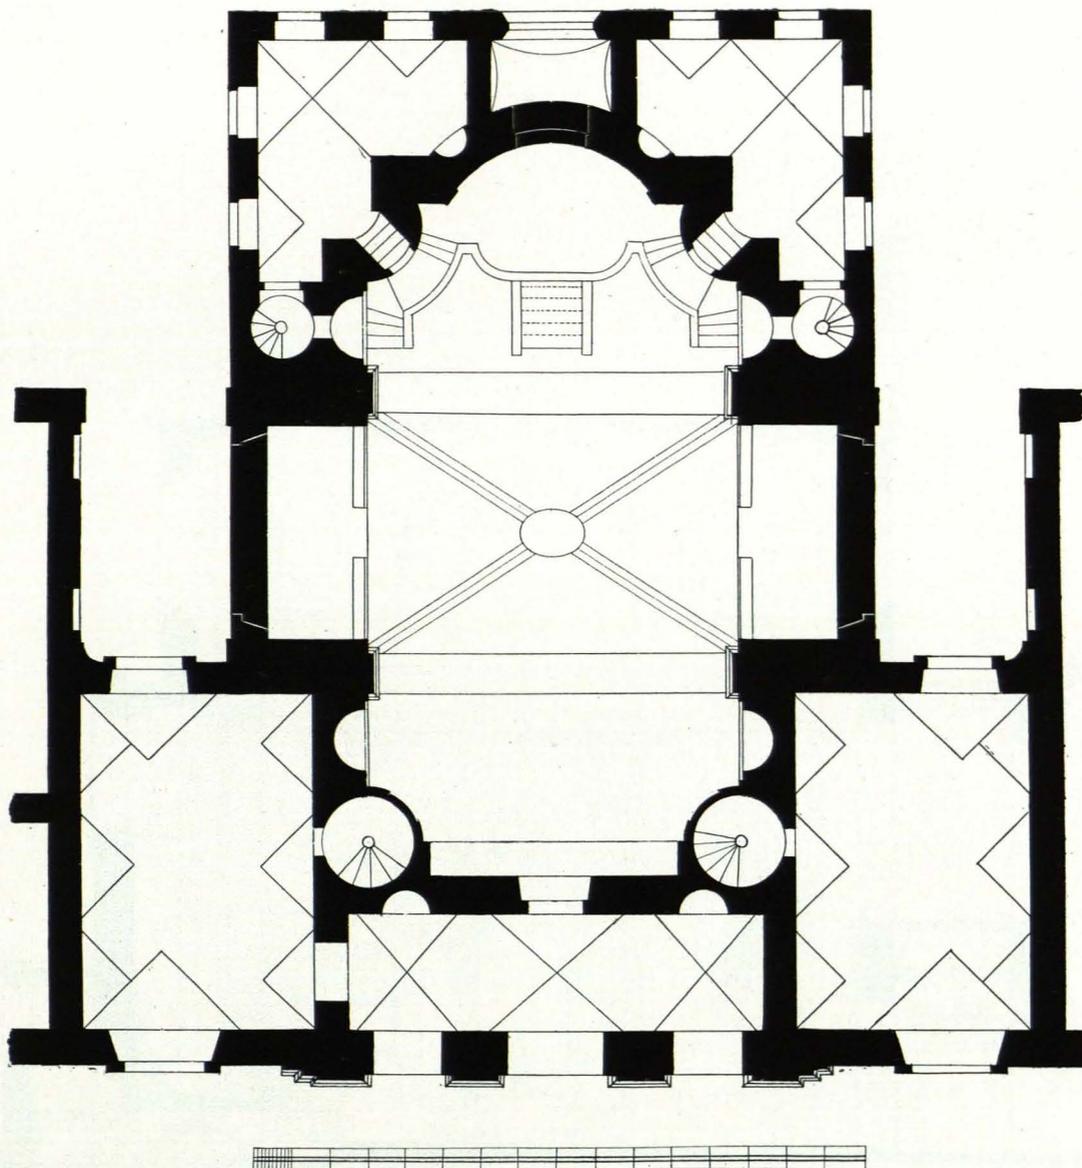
Johannesspitalkirche, Grundriß 1 : 200 (S. 258)
